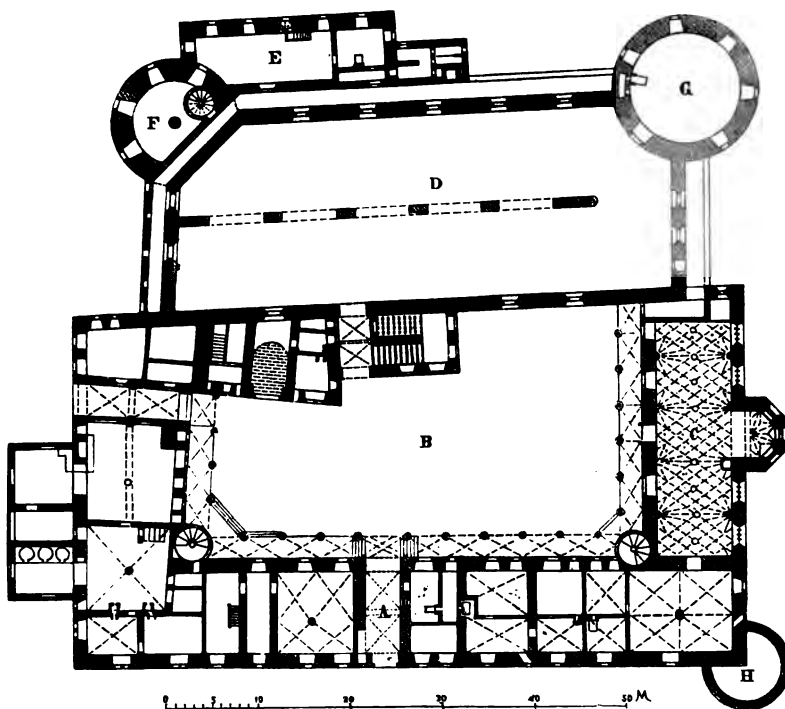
Stuttgart, altes Schloß. Grundriß des Erdgeschosses.
